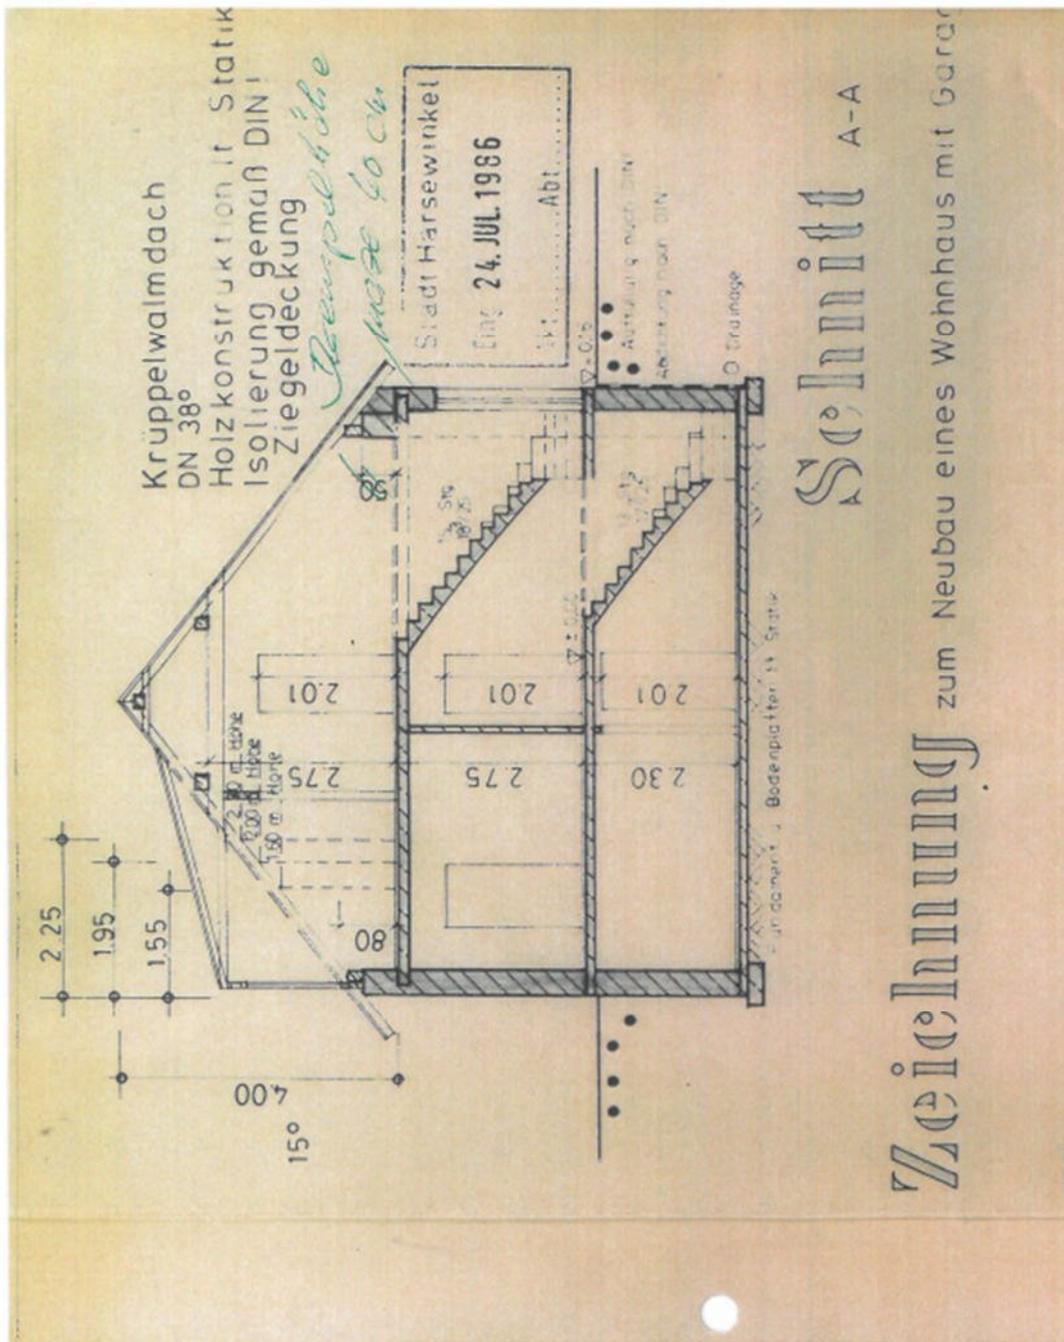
Querschnitt / Plan aus der Bauakte Abweichungen vor Ort sind möglich
